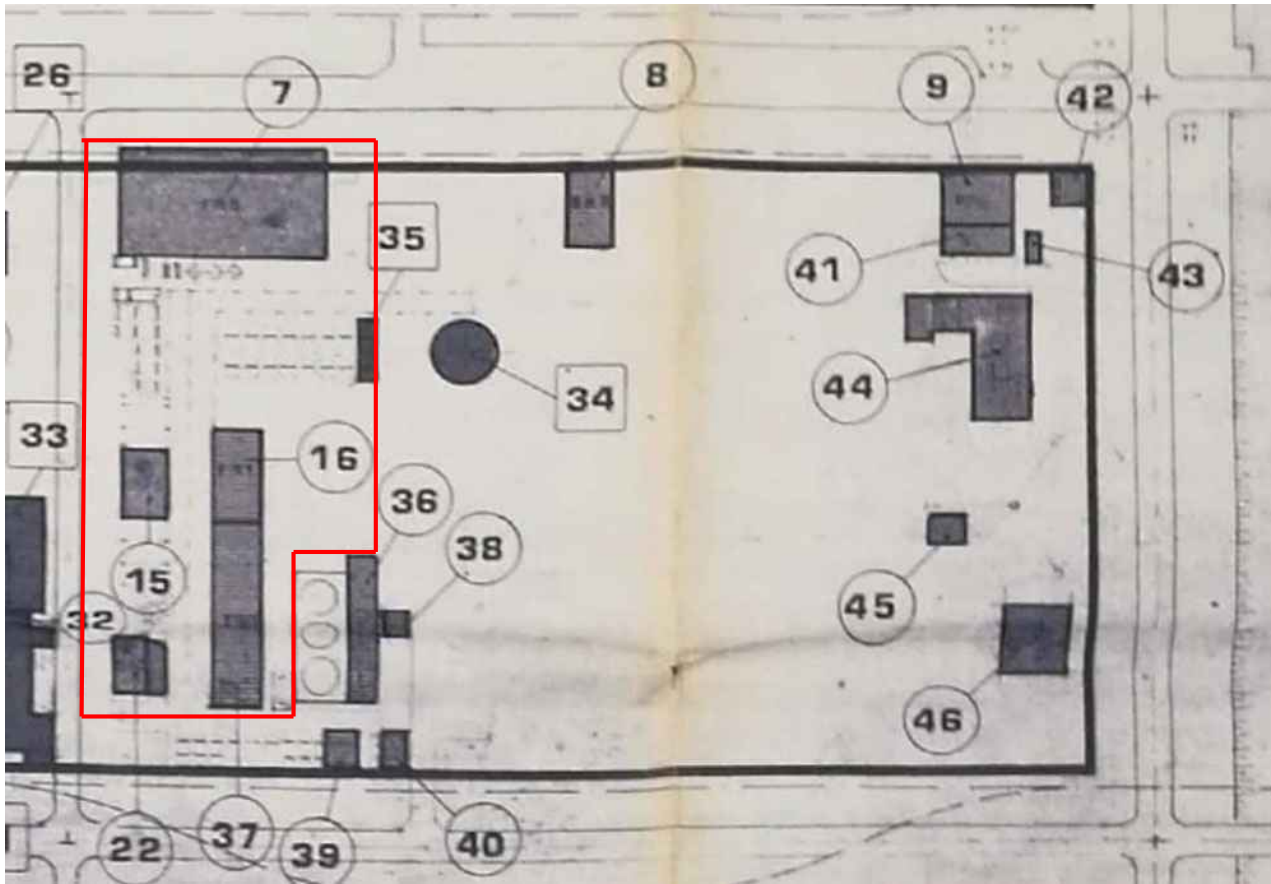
Planimetria generale condono edilizio 1985 all. G23 -Condono planimeria generale pratiche.pdf
